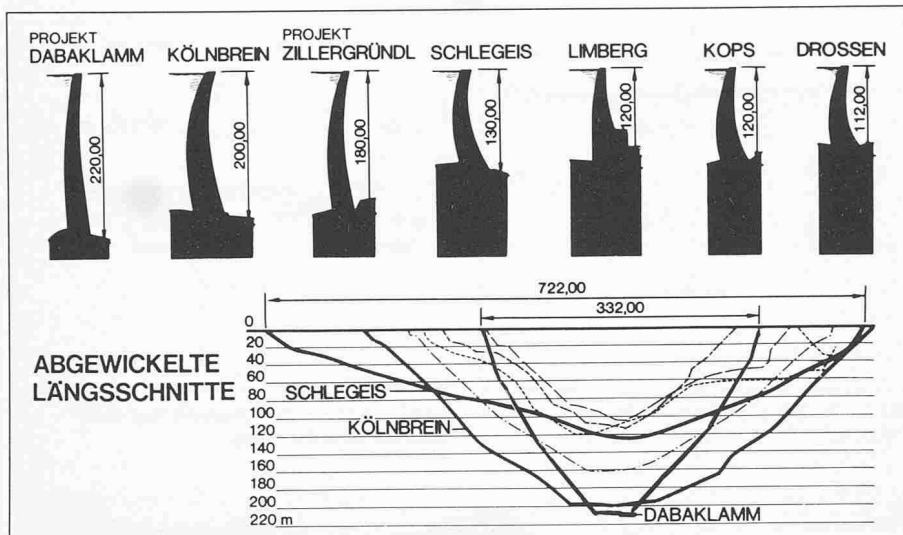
Quer- und Längsschnitte österreichischer Gewölbemauern im Sperrbau
